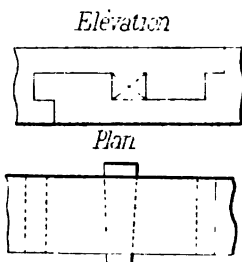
Assemblage à mi-bois avec tenon d'about et clef.
